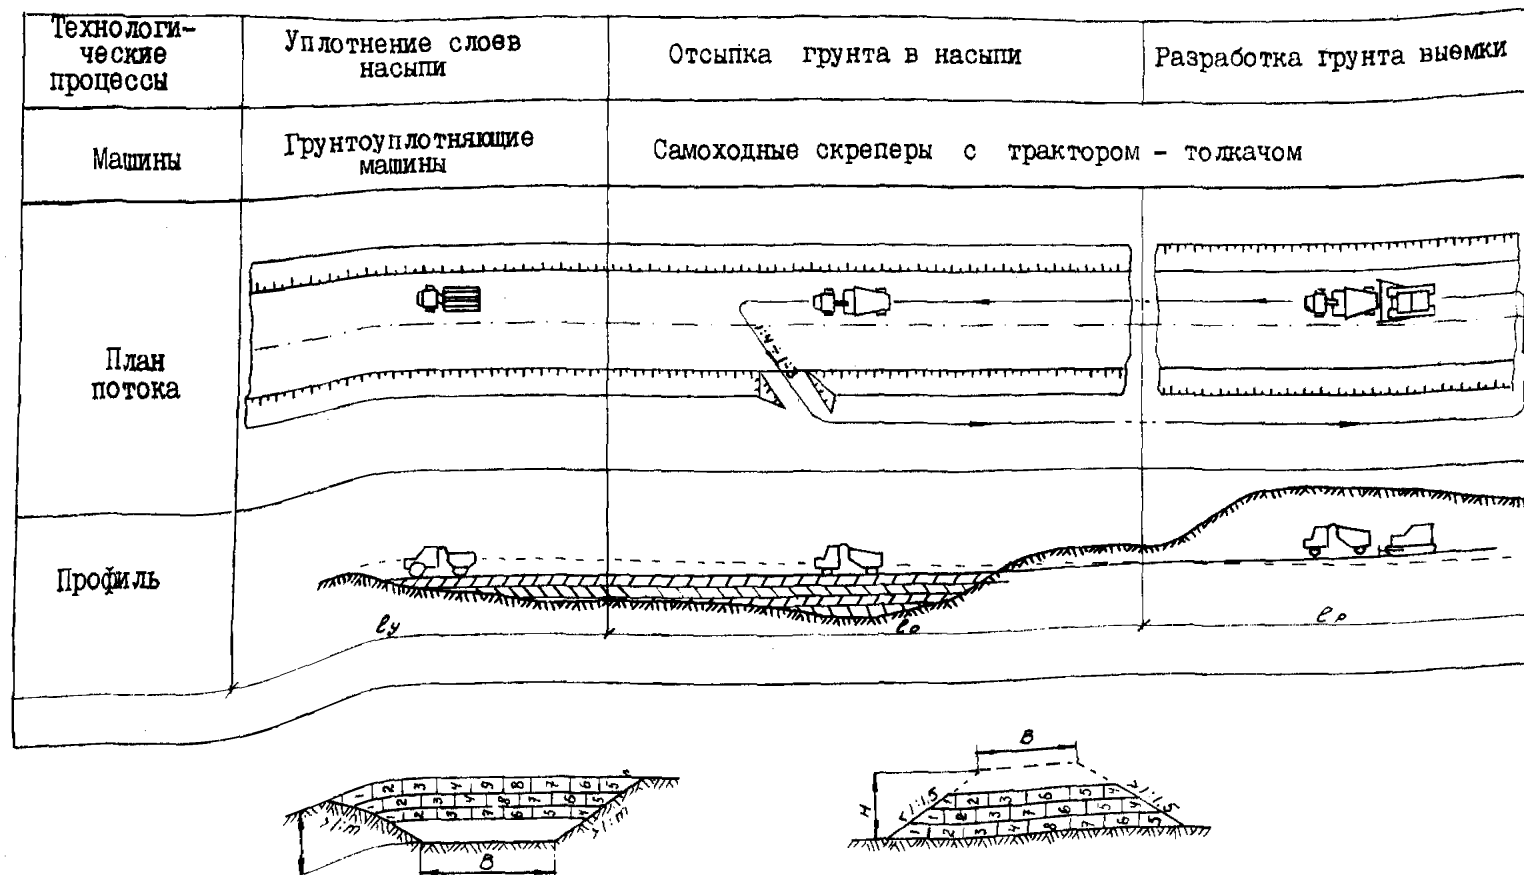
Схема разработки выемки скреперами с перемещением и укладкой грунта в насыпь
